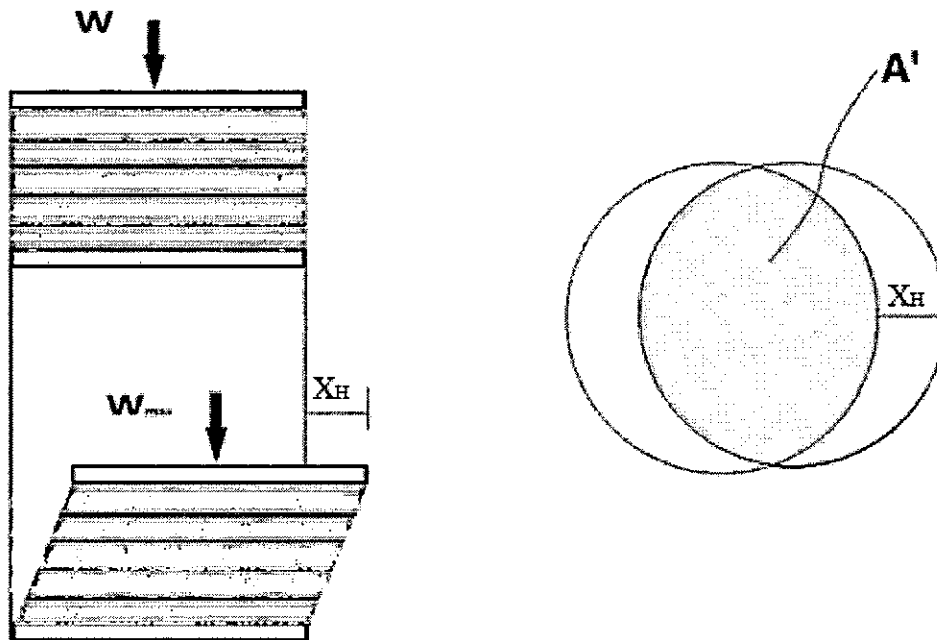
Zona de superposición entre la zona fija y la zona desplazada una distancia X_H del aislador.
